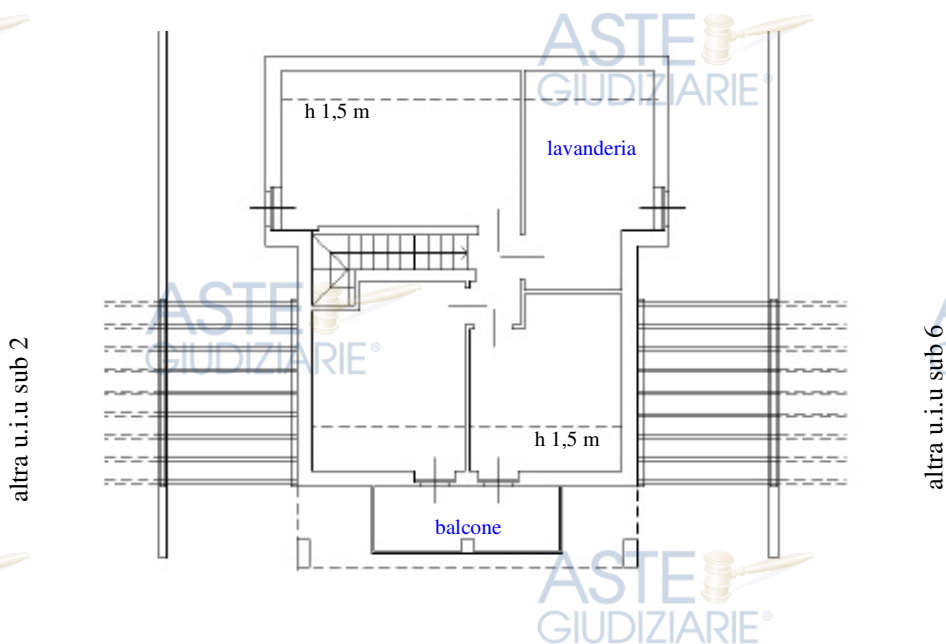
Planimetria non in scala del piano sottotetto del villino sub. 4 (anche All. n. 6)
